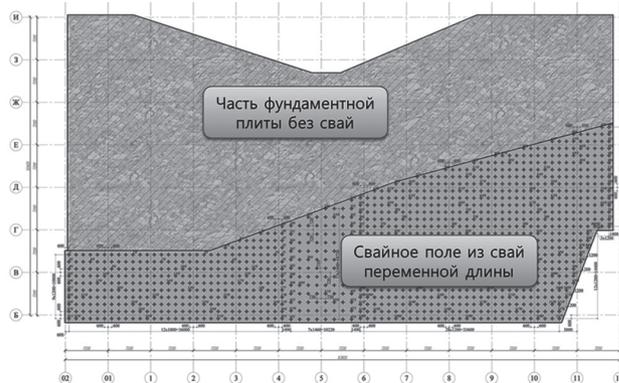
Схема расположения элементов вертикального армирования основания высотного жилого здания
